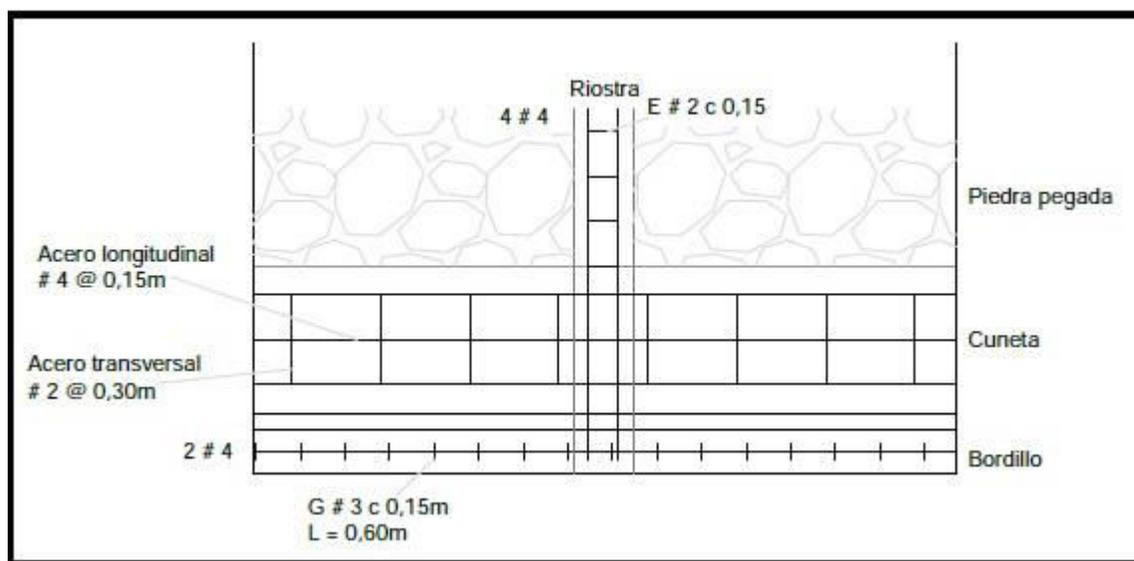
Vista en planta Berma-cuneta y Bordillo.
